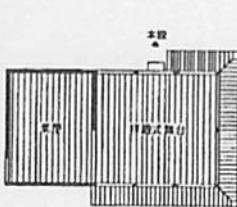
豊前の典型的平面図 図3-6 豊津の典型的平面図
